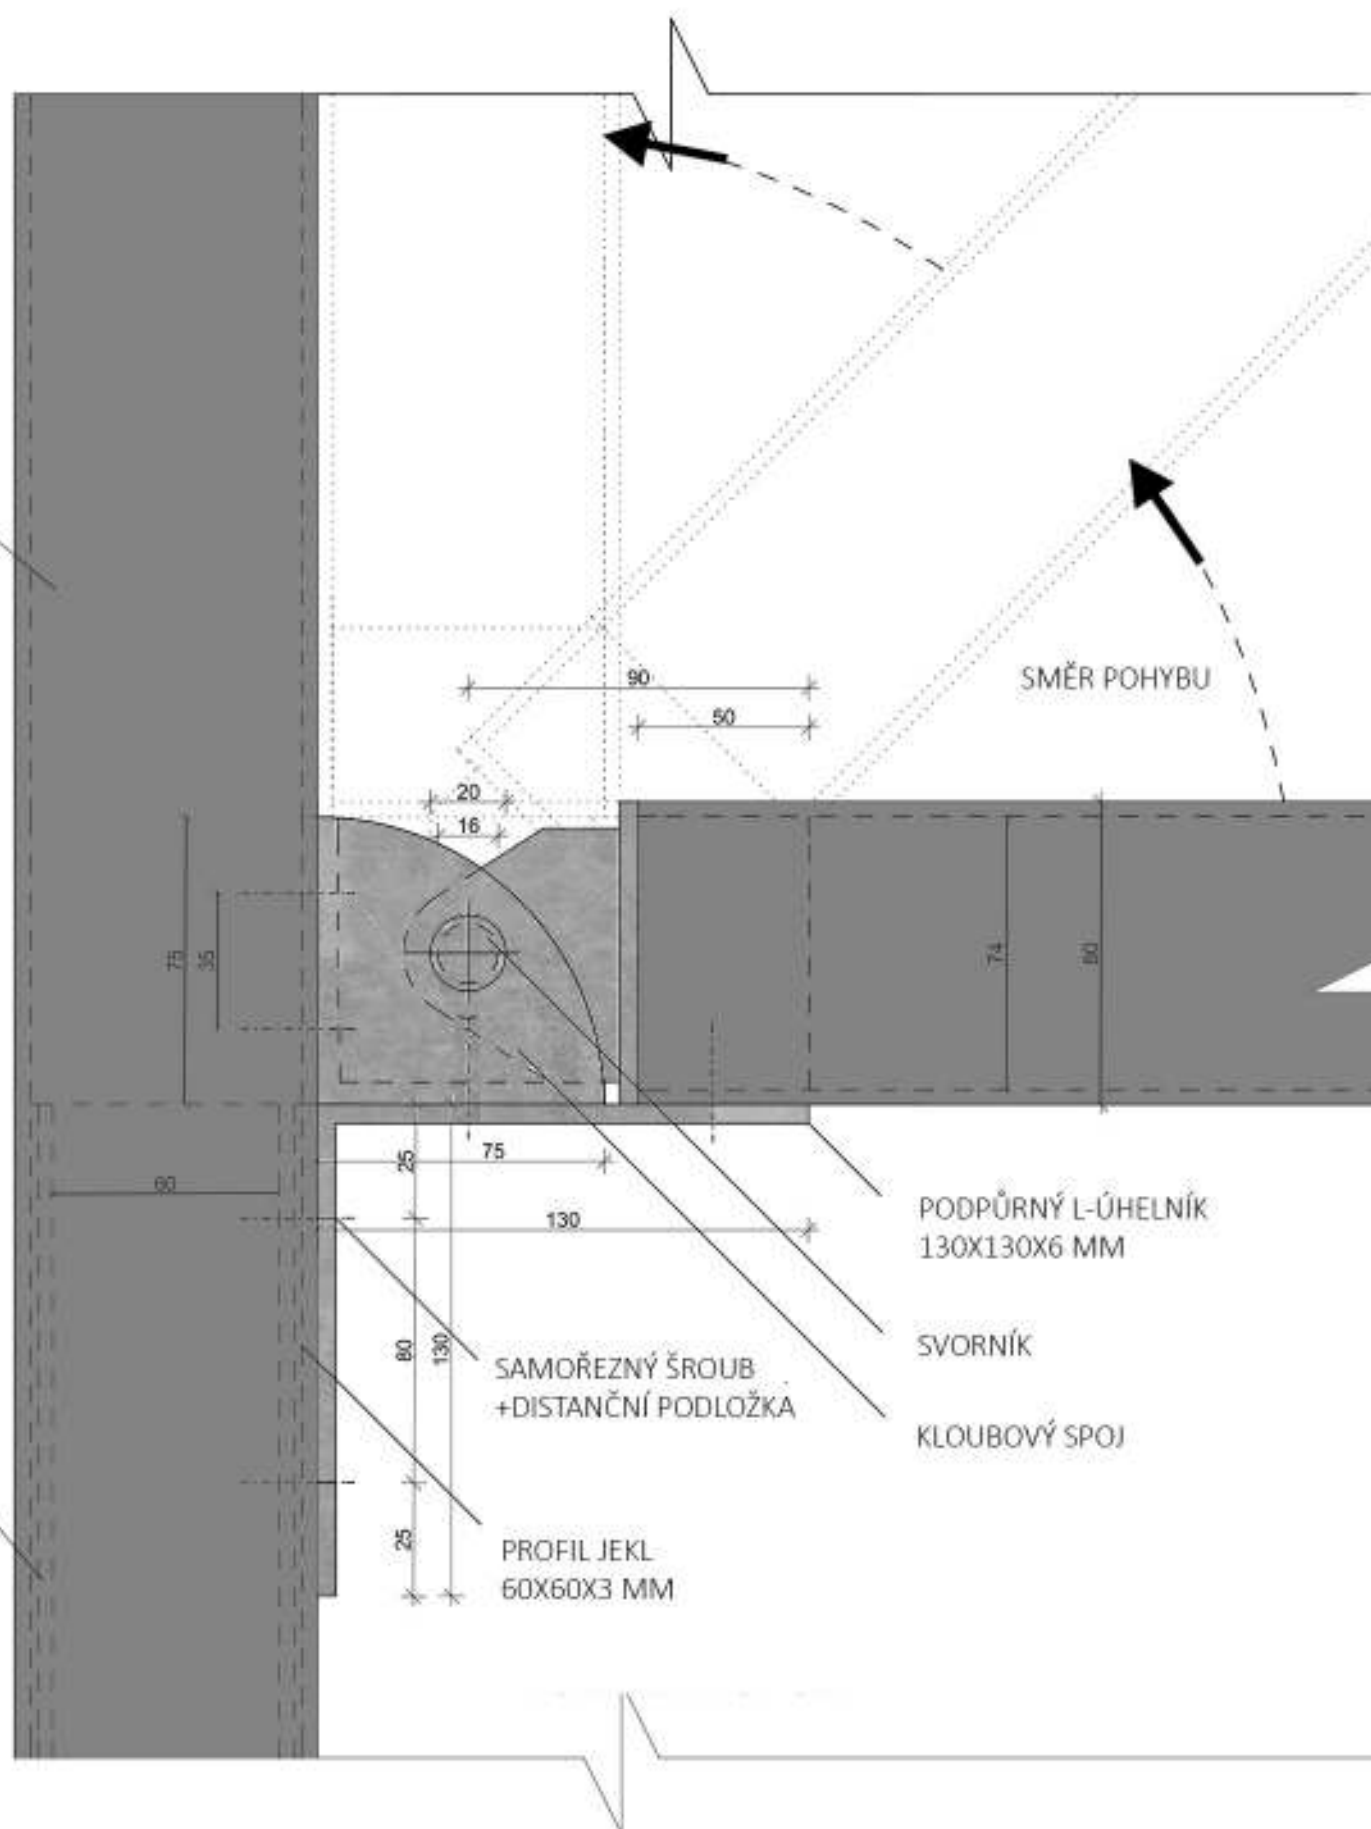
DETAIL A - NAPOJENÍ VODOROVNÉHO PROFILU NA SVISLÝ SLOUPEK
